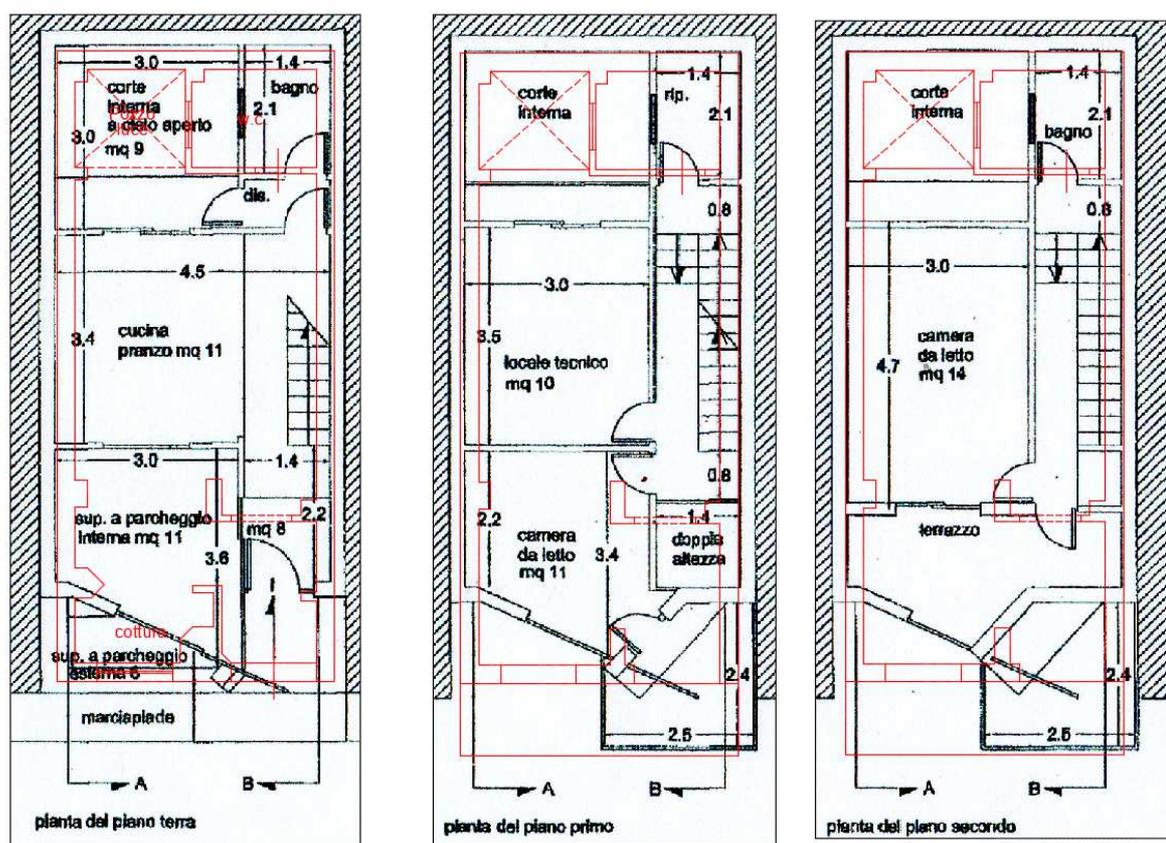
Sovrapposizione delle planimetrie (stato attuale/progetto)
